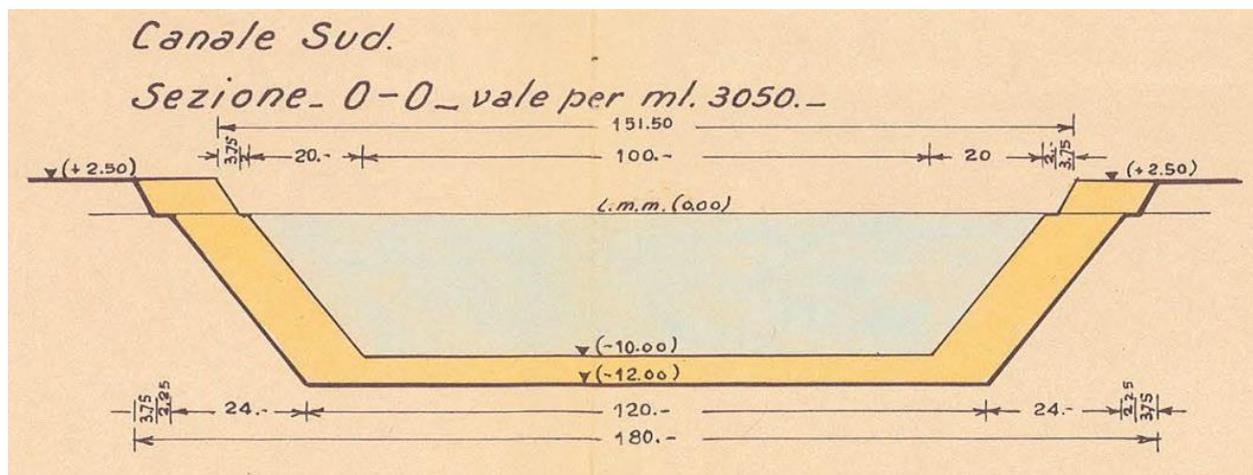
Estratto PRP 1965 – Sezione 0 - 0
